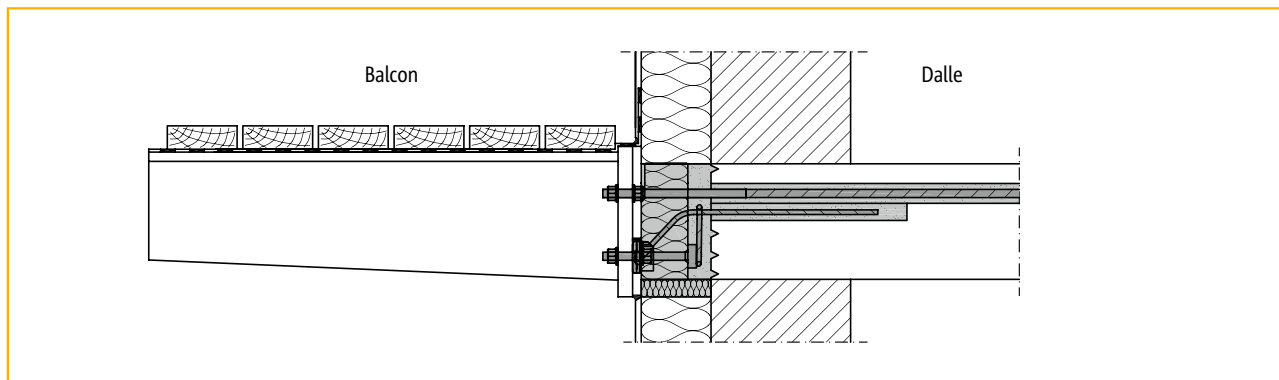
balcon en porte-à-faux avec modèle RKS14 lors de la rénovation d'un balcon existant
